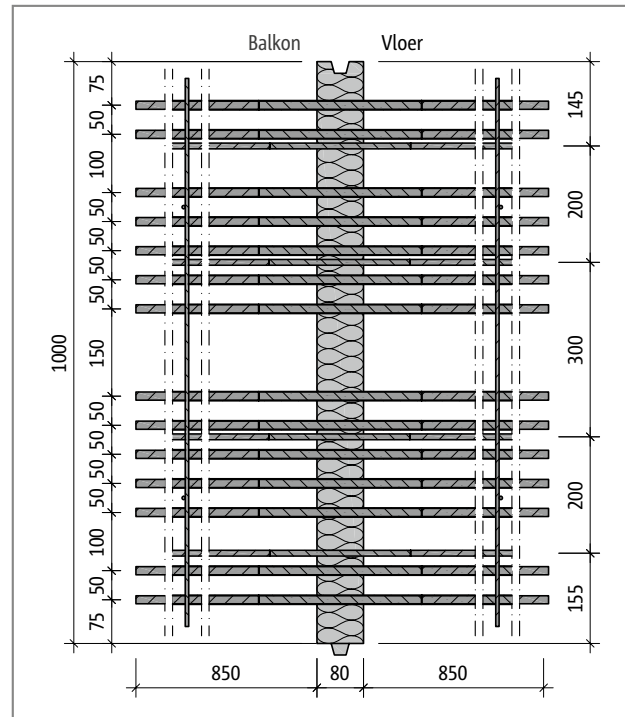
Schöck Isokorb® T type K-M12: Zijaanzicht
